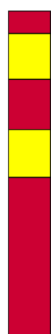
Przykładowy element separatora U-307e/f
